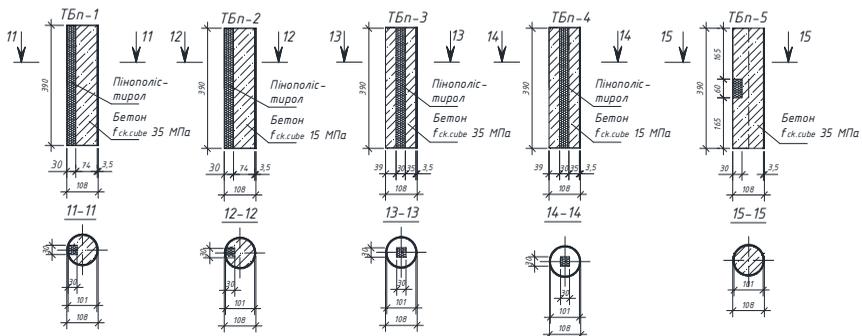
Схема бетонування труботонних елементів з порожнинами та раковинами
